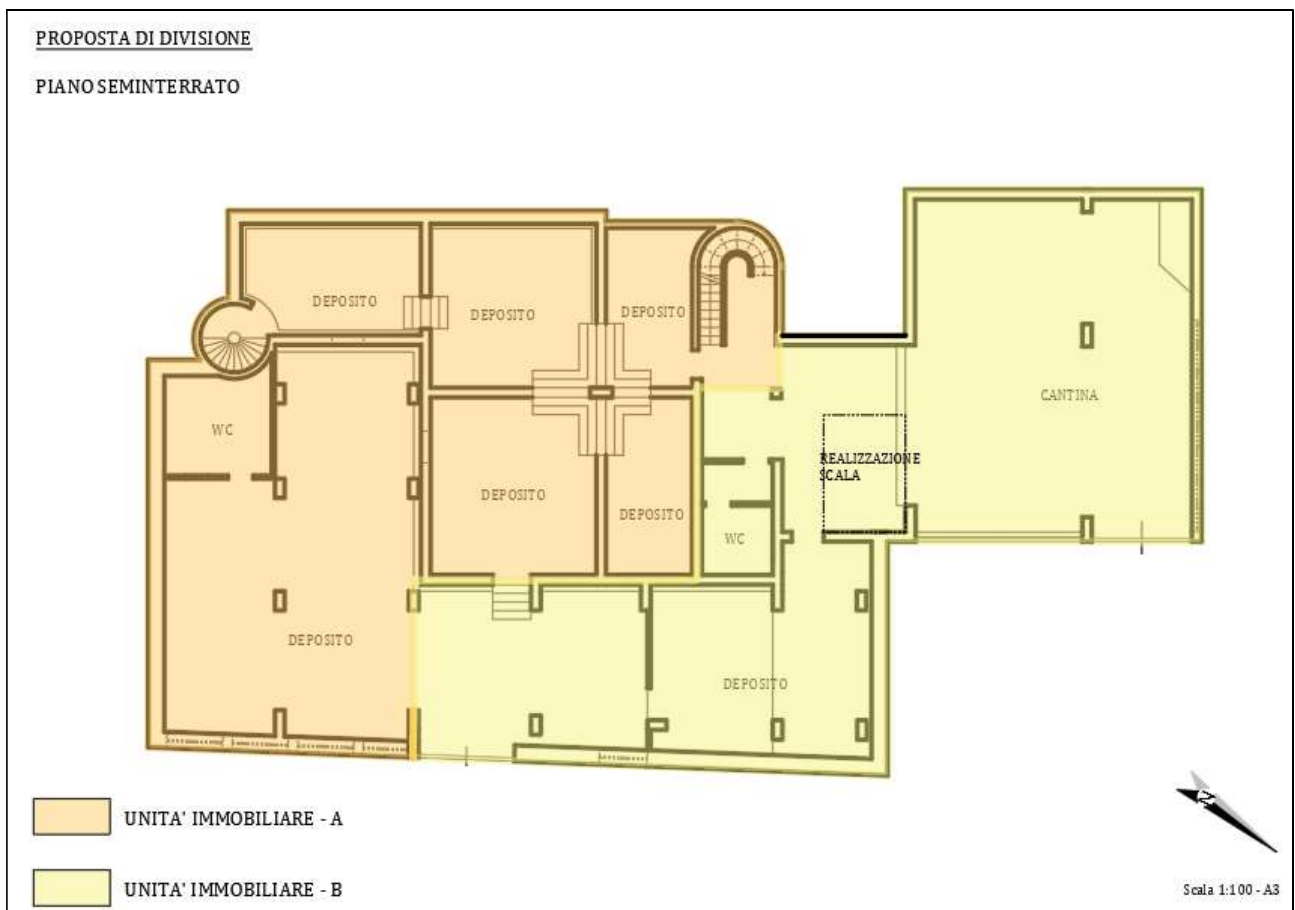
Planimetria dell'immobile PROPOSTA DI DIVISIONE – Piano seminterrato
